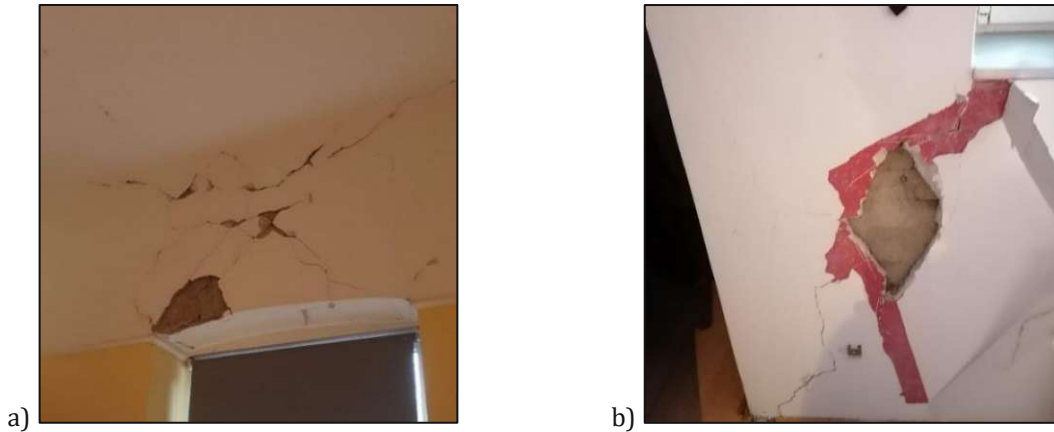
Exemplarische Schadensbilder an der tragenden Mauerwerksstruktur mit a) Objekt 23 – kreuzförmige Risse am Fenstersturz (S3) und b) Objekt 26 – Rissausbildung am Parapet (S3).
